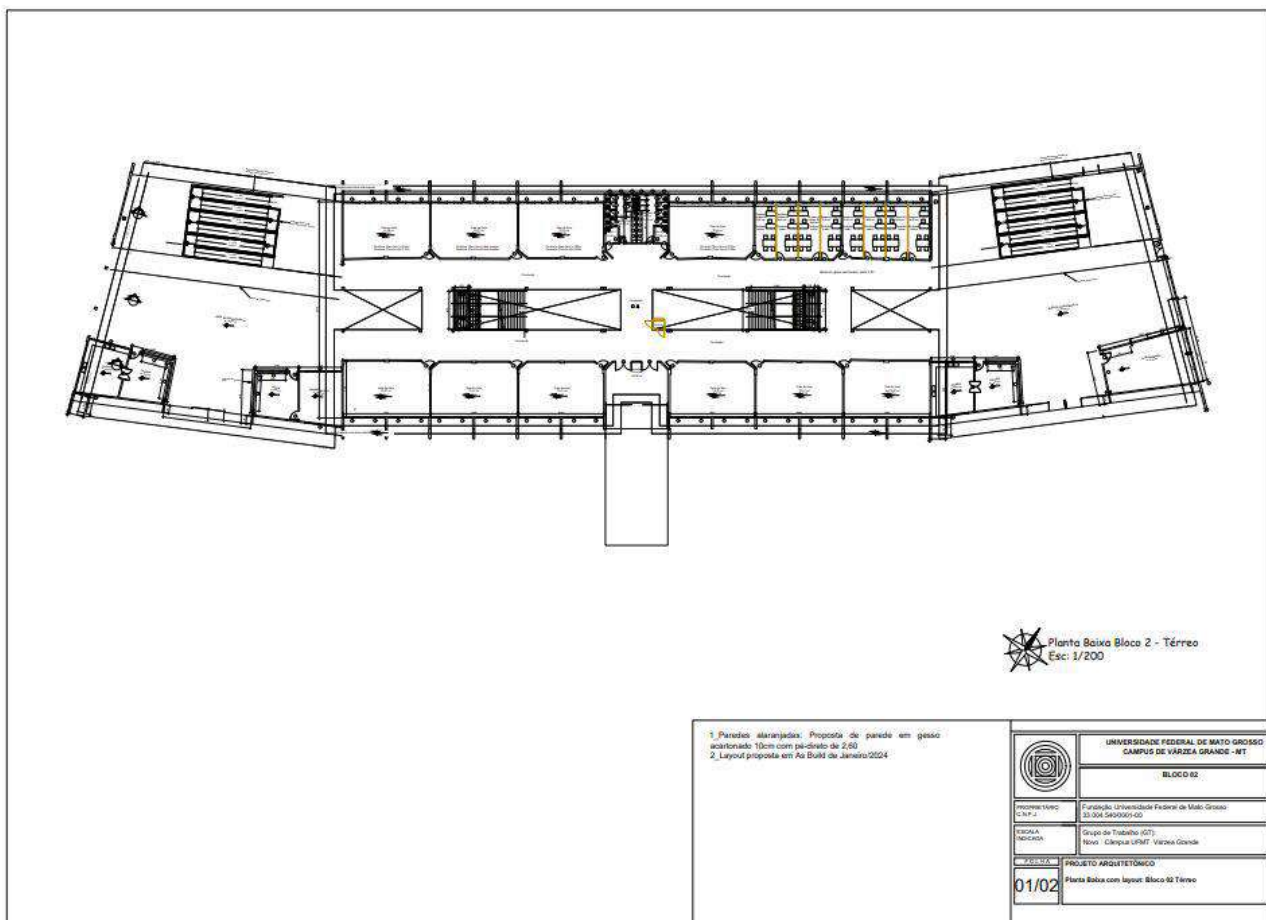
Proposta de adequação do pavimento térreo do Bloco 2.
